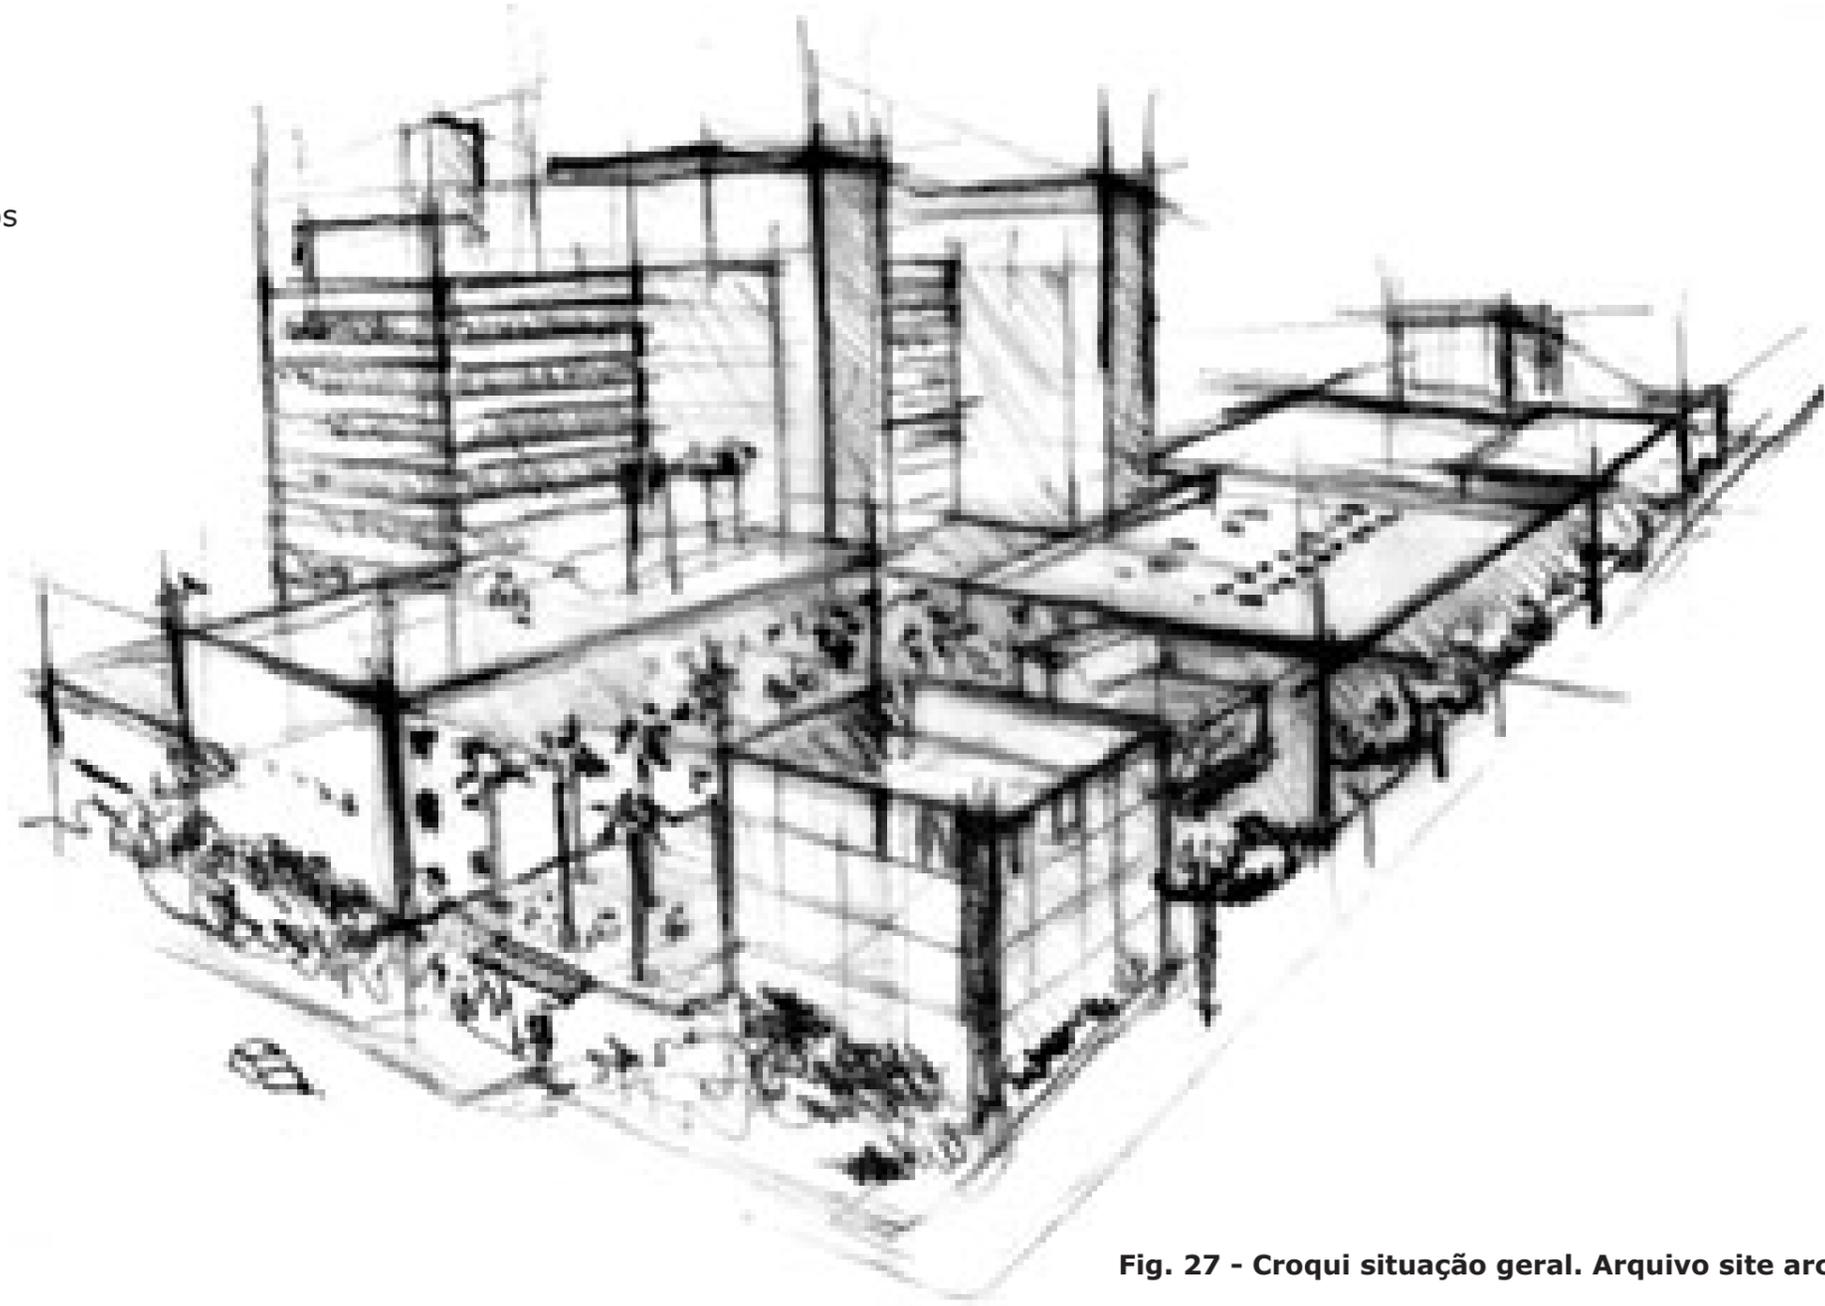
Croqui situação geral. Arquivo site arcoweb
